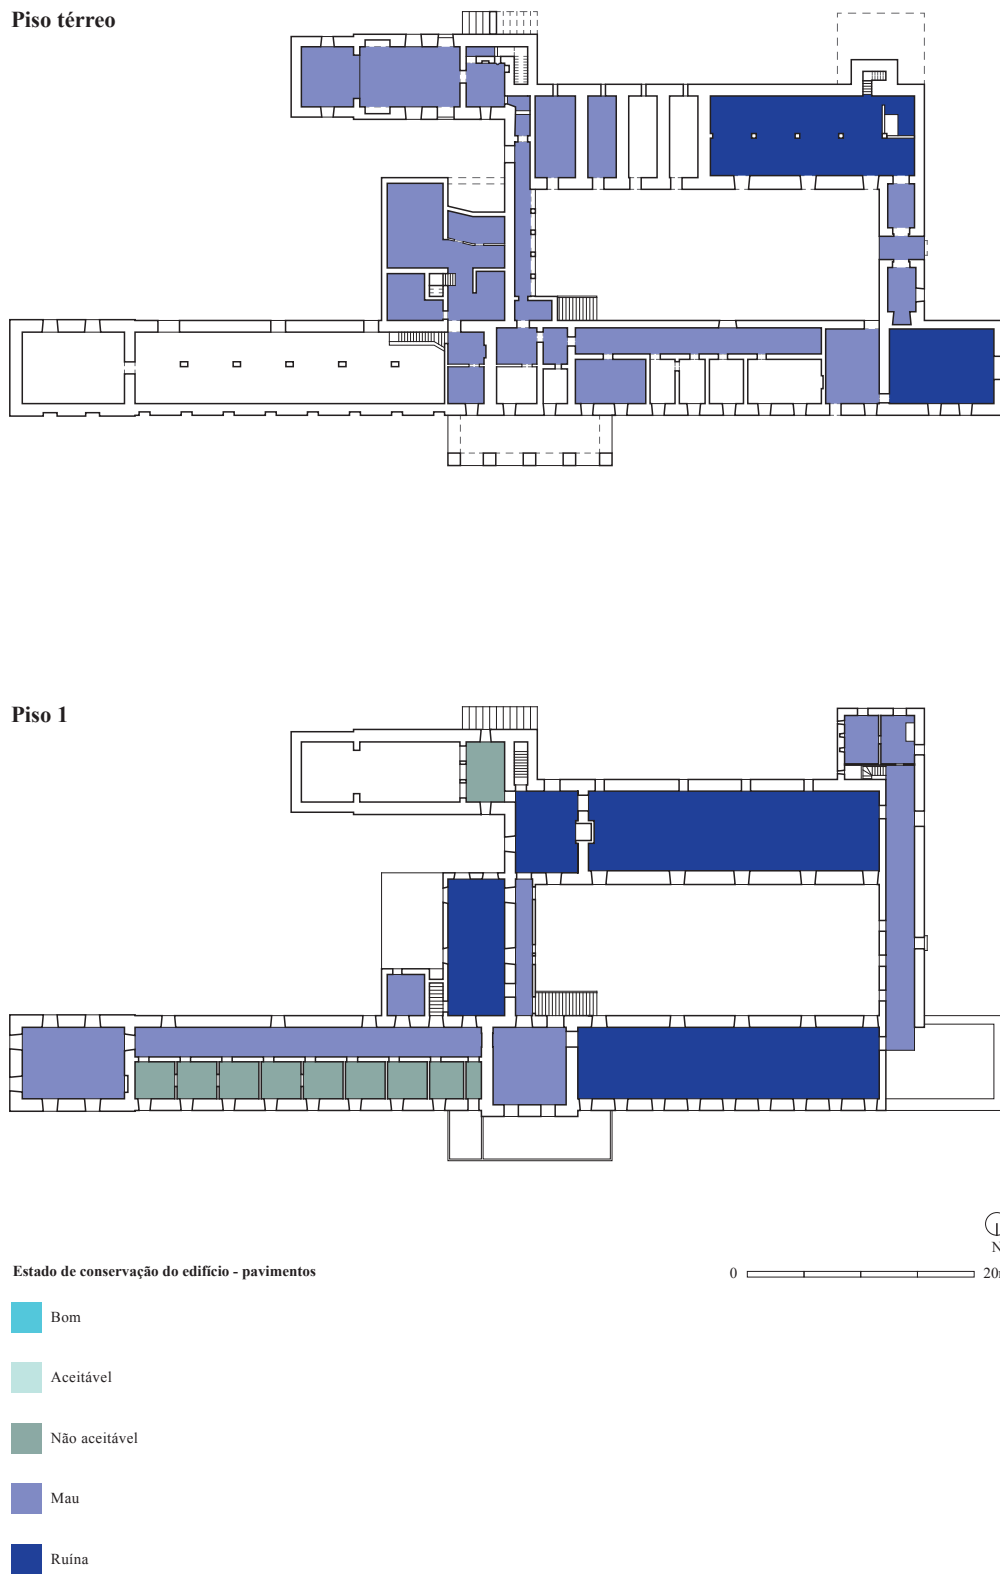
Mapa do estado de conservação do edifício - pavimentos
